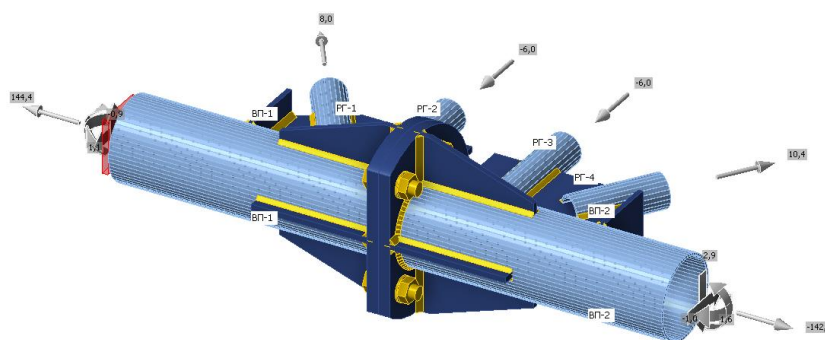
Монтажный стык нижнього поясу просторового блоку ферми
